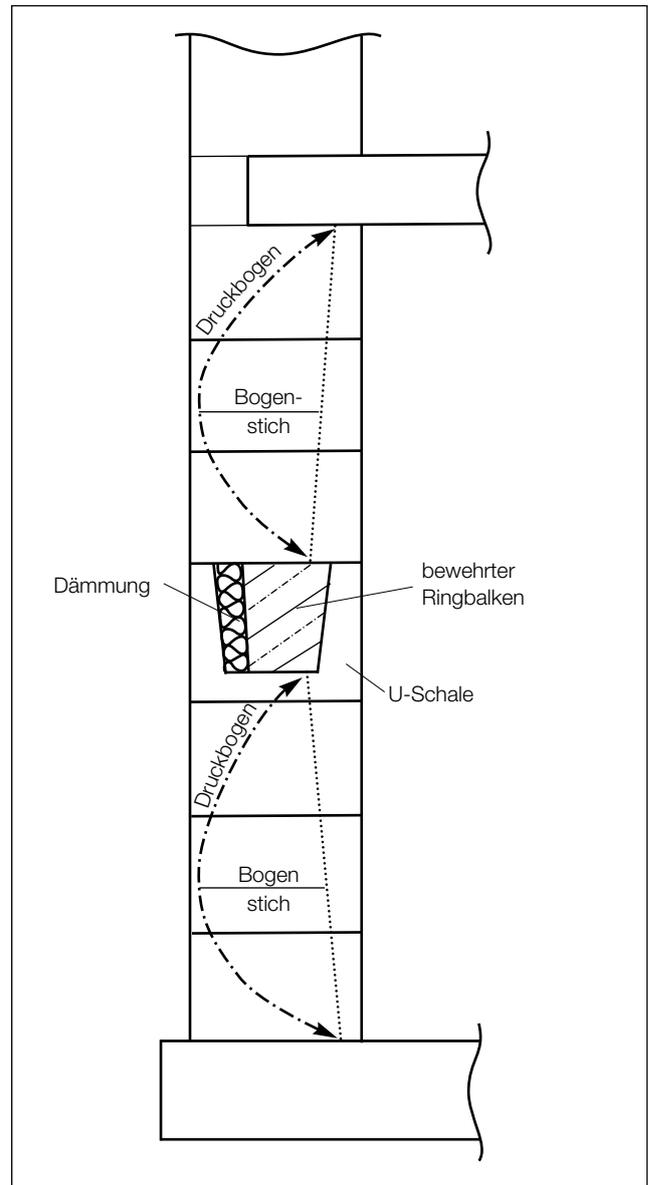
Kellermauerwerk mit horizontalen Stahlbetonbalken (Schnitt).
